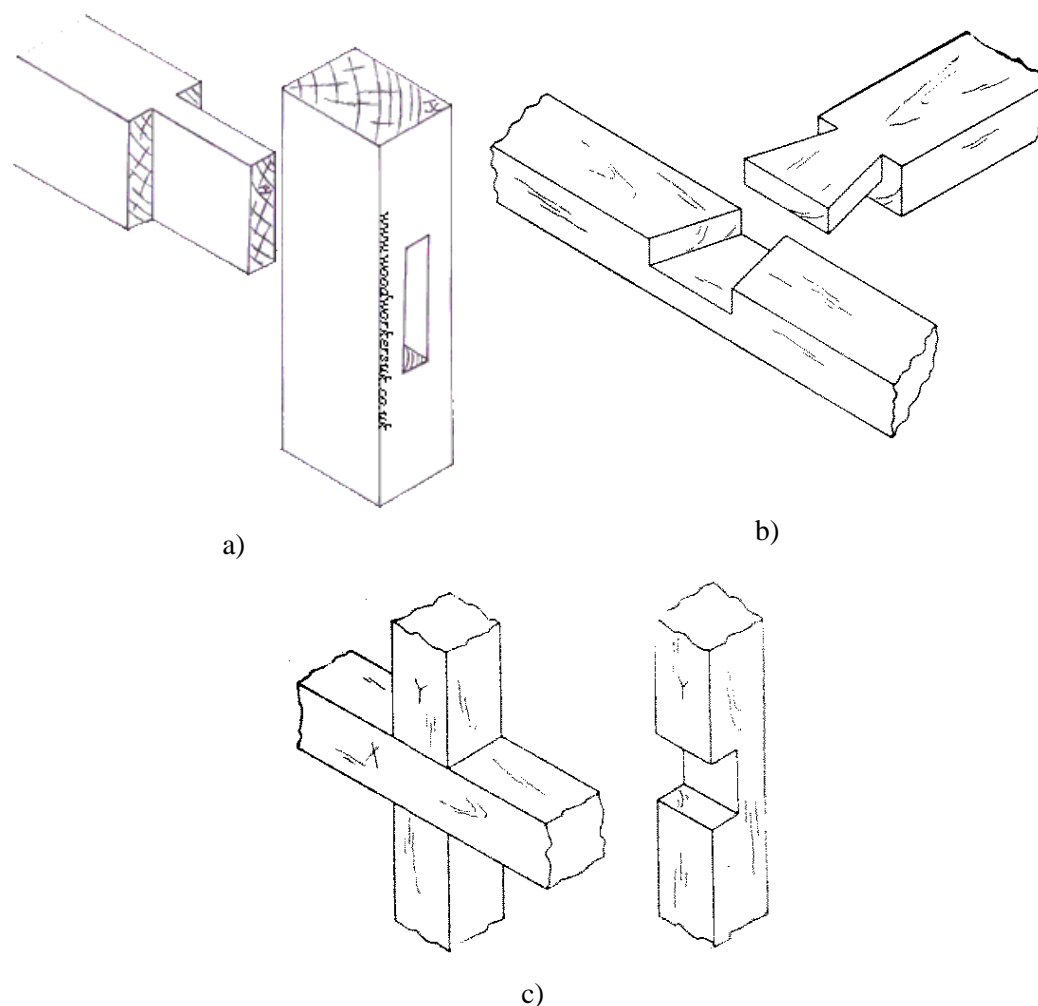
Ligações entalhadas: a) cachorro [38]; b) e c) nós de cruzamento [39].
